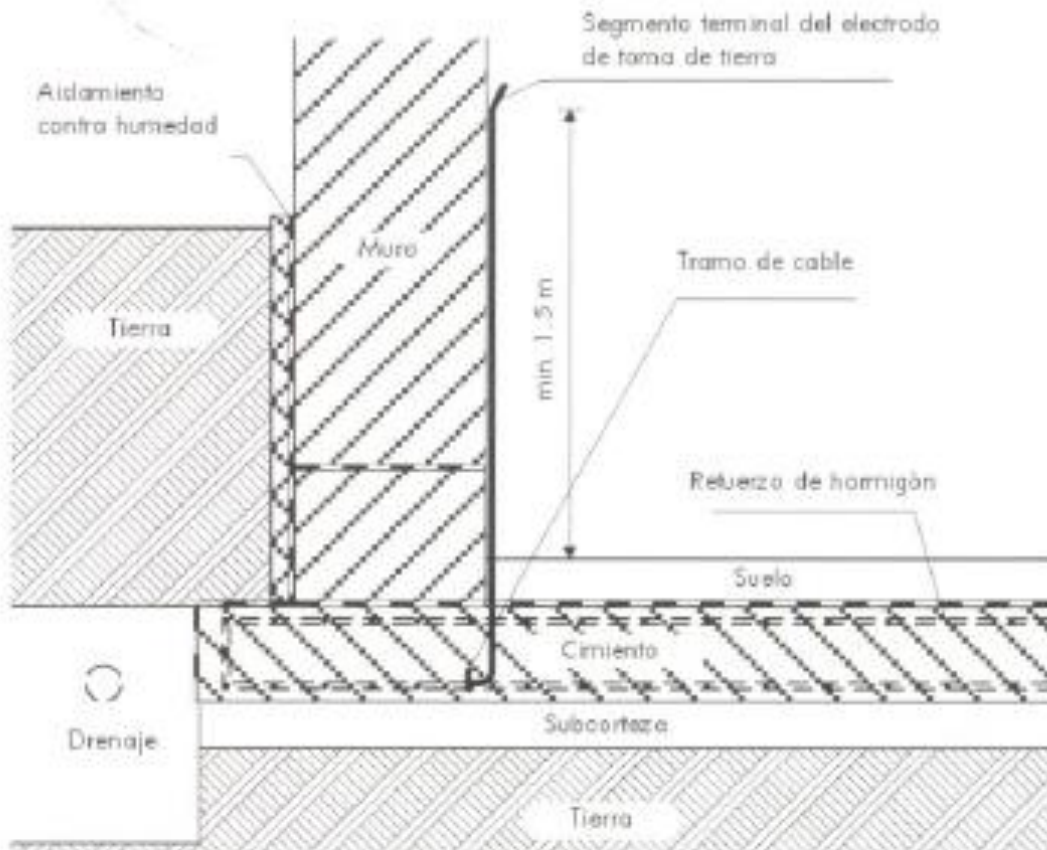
Ilustración de la colocación de un electrodo de toma de tierra en una cimentación con refuerzo en el hormigón
